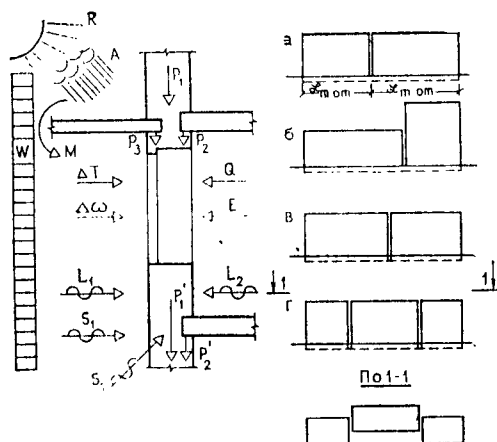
Нагрузки и воздействия на конструкцию наружной стены
